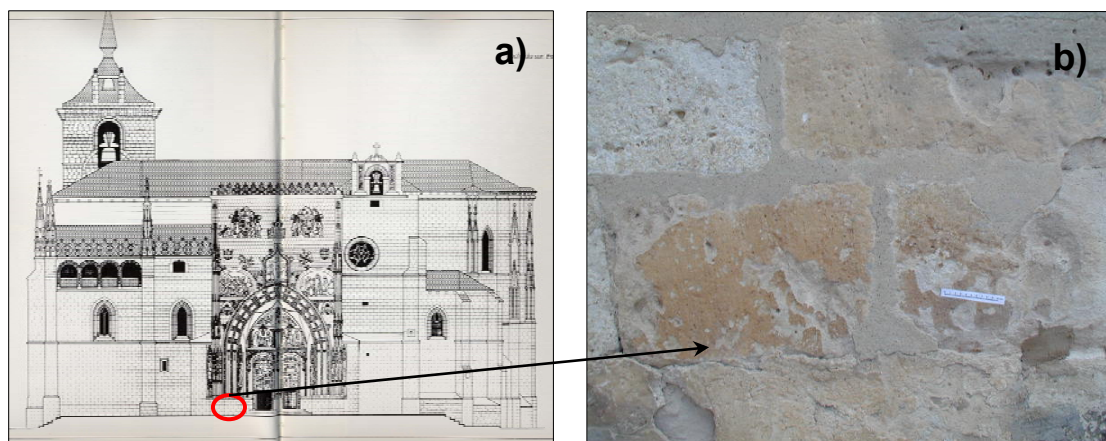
a) Alzado de la fachada principal de la iglesia de Santa María la Real (Aranda de Duero) (Abad Zapatero y Arranz Arranz, 1989) donde se sitúa la zona de muestreo; b) detalle de las pátinas en la fachada.
